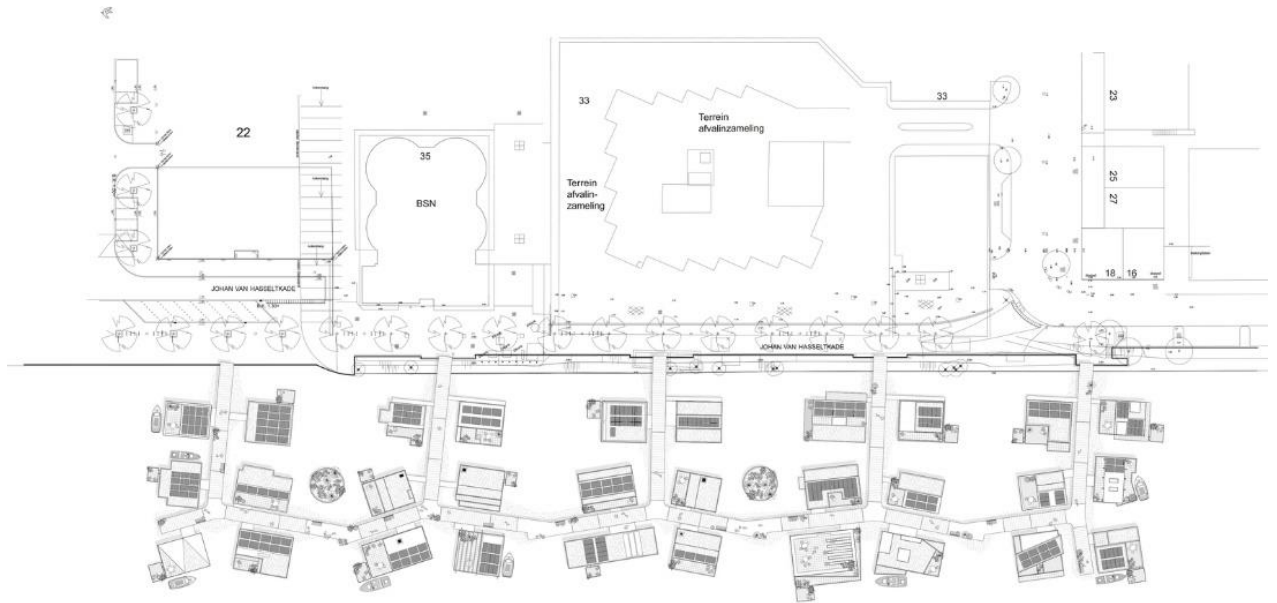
Генеральний план Amsterdam's Floating Neighbourhood Schoonschip [23]
